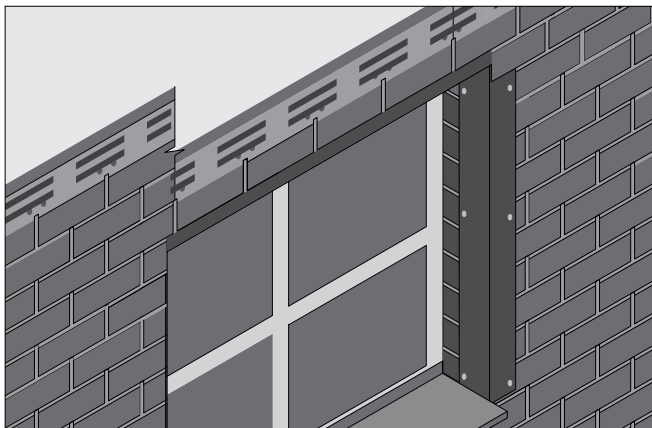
Монтаж фасадной плитки поверх оконного наличника сверху проема
